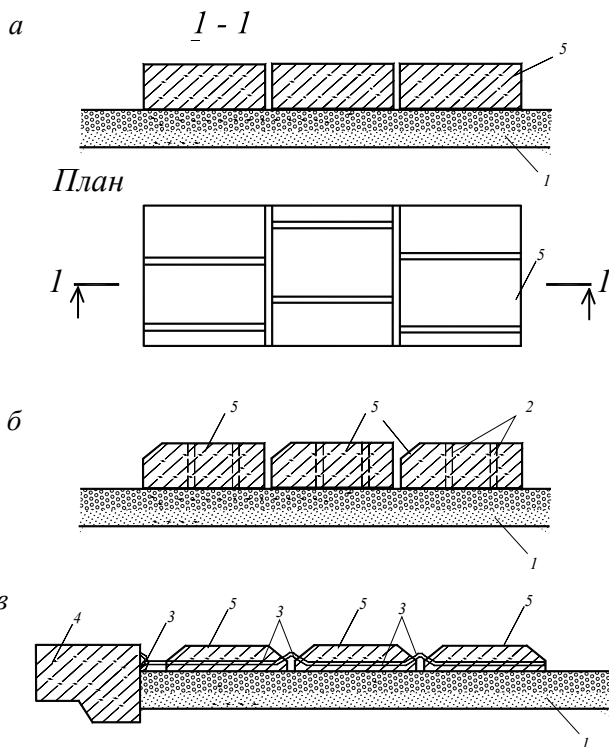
Крепление рисбермы бетонными плитами:
